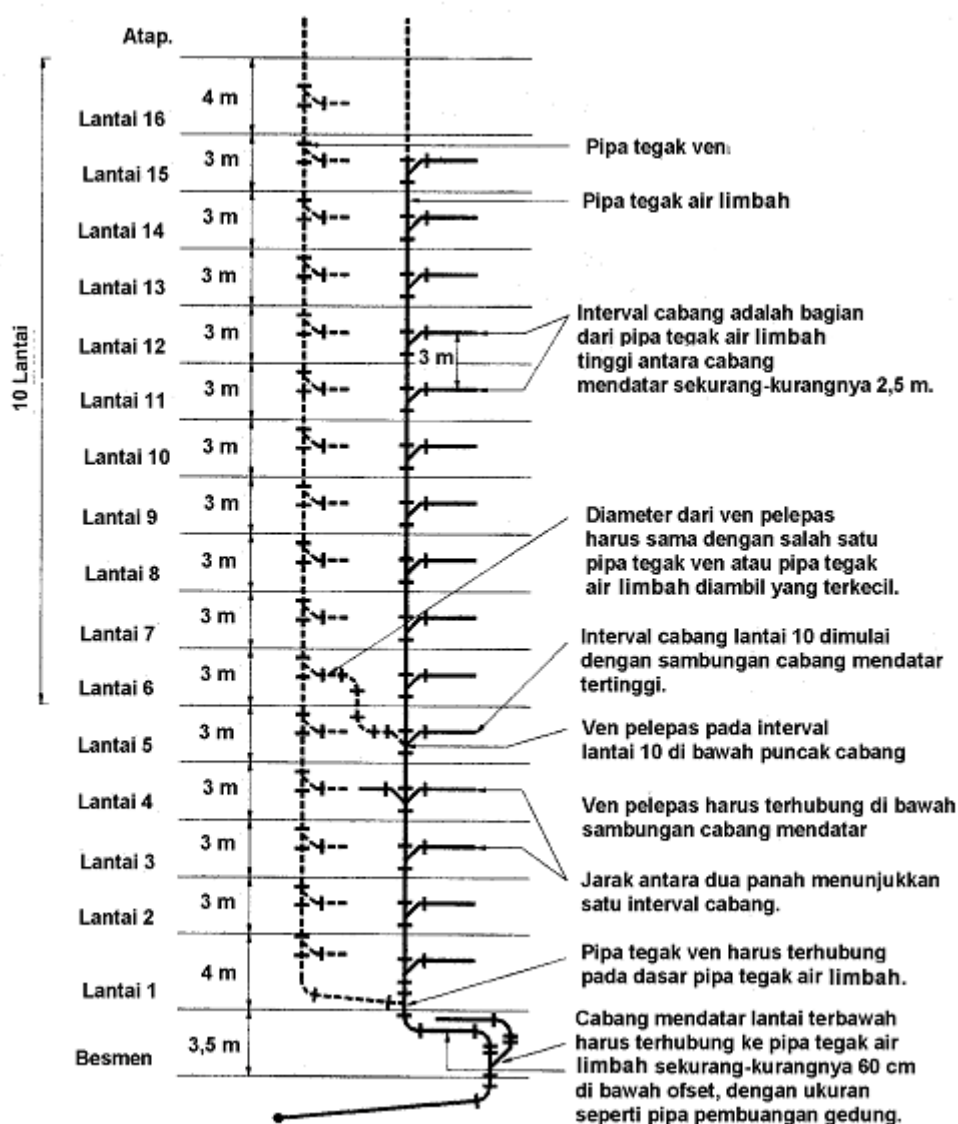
Offset tegak pada saluran pembuangan bangunan gedung
